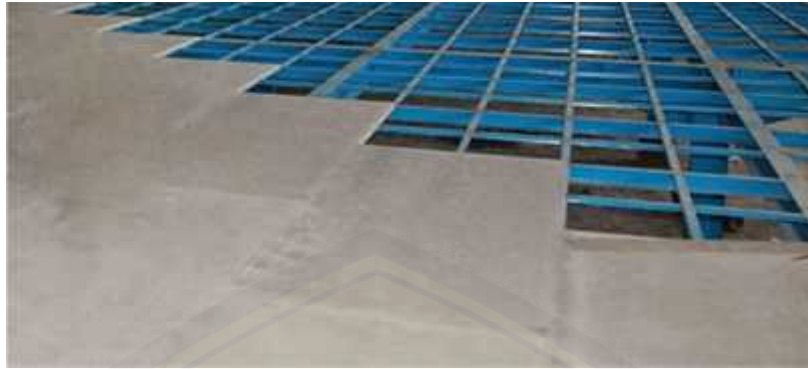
Proyek Lantai 2 bangunan pergudangan
